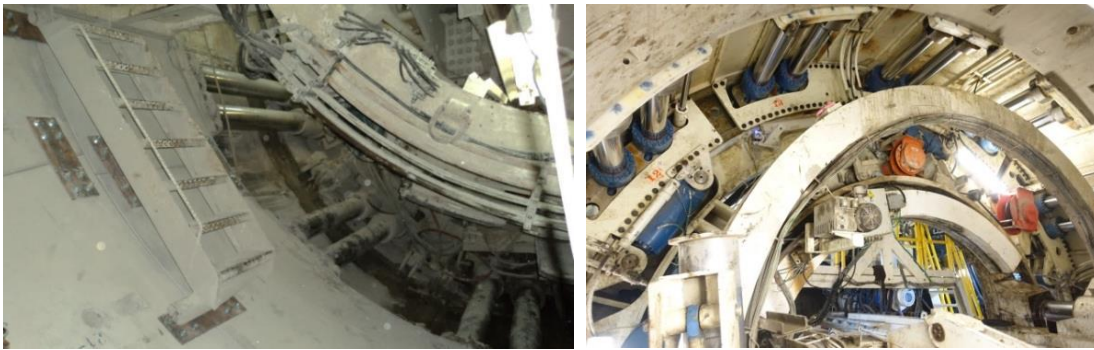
Apoyo de la tuneladora en las dovelas durante el proceso de excavación.
